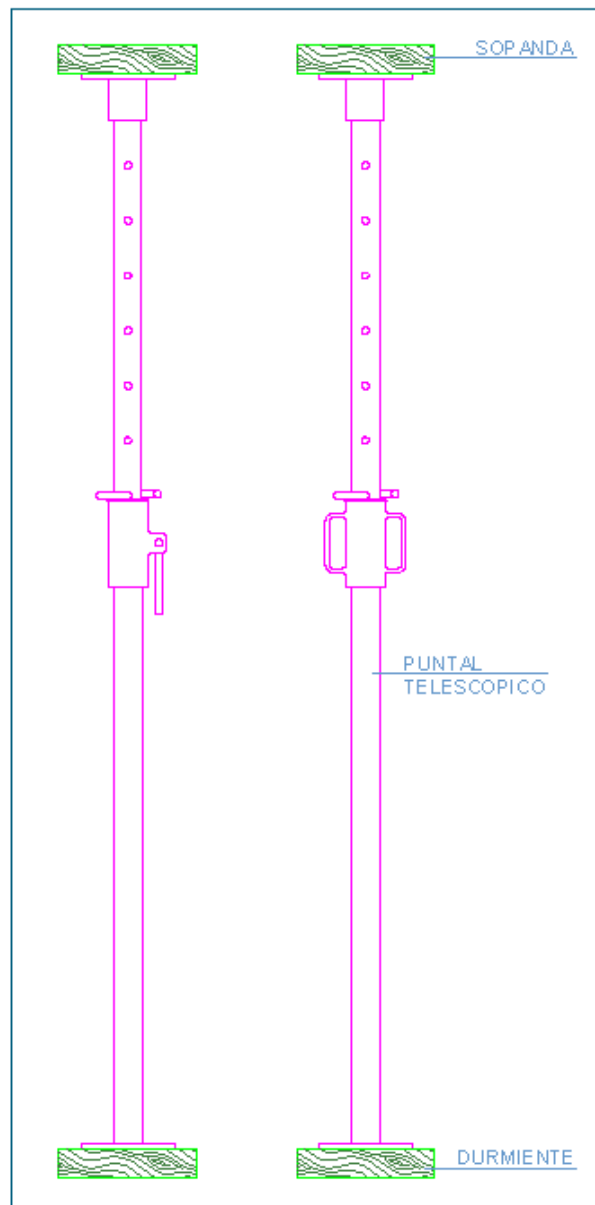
EJEMPLO DE PUNTALES PARA VIGAS Y COLUMNAS
